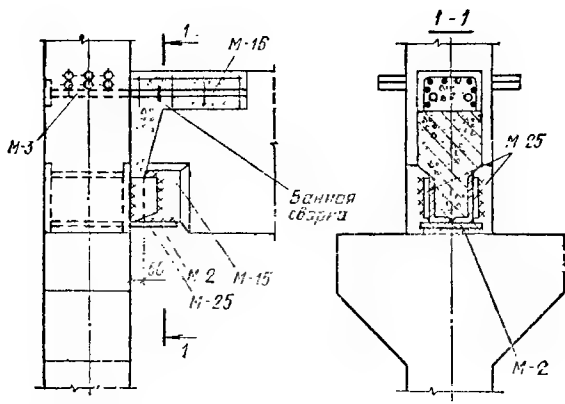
Крепление продольного ригеля к колонне (поперечные ригели на рисунке условно не показаны)
